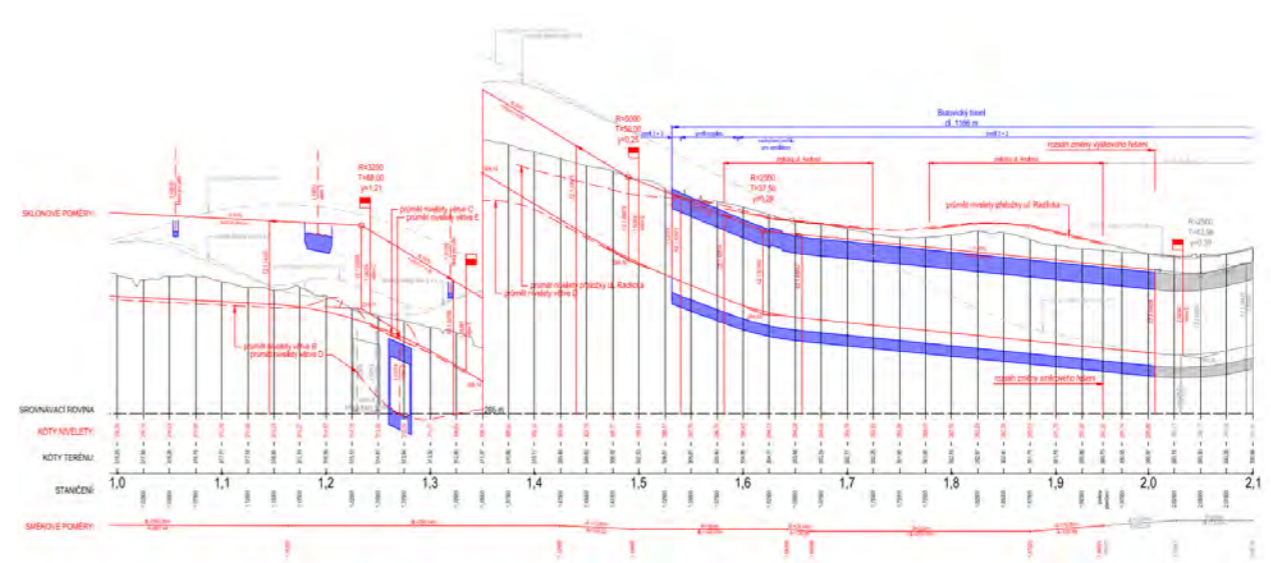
Úsek Botanica – podélný profil RR varianta A
